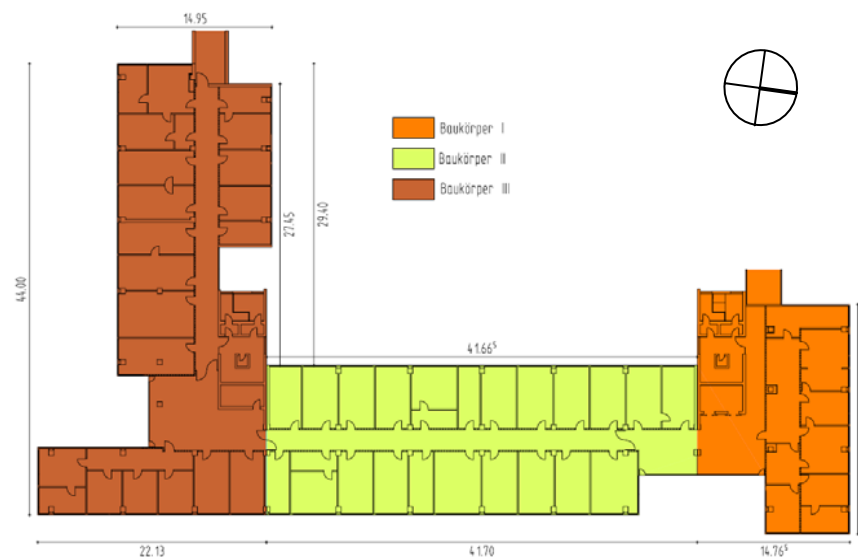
Grundriss - Regelgeschoss (2.OG)
